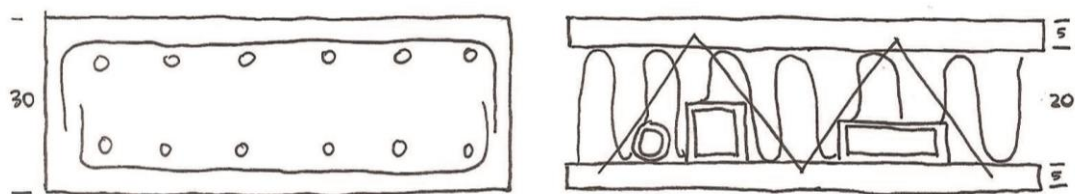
A la izquierda forjado tipo losa realizado en hormigón tradicional. A la derecha nuevo prototipo de forjado prefabricado con HUAC tipo "sándwich" con instalaciones y aislamiento en su interior.
